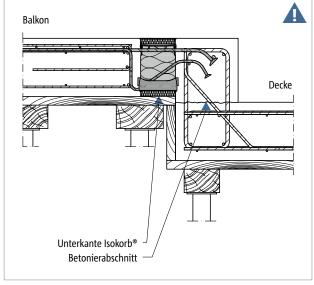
Schöck Isokorb $^{\otimes}$  XT Typ K-U: Ortbetonbalkon mit Höhenversatz nach unten
